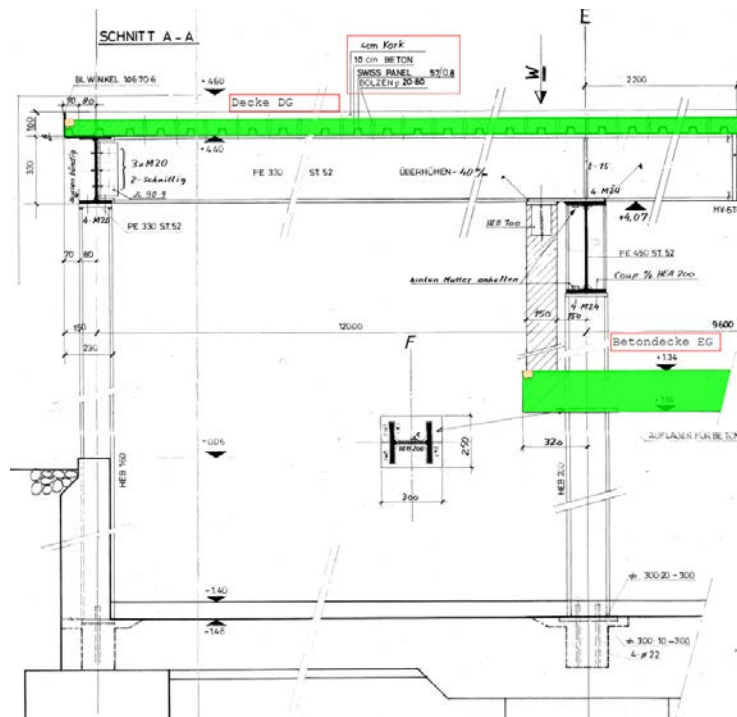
Schnitt und Detail Erd-Dachgeschossdecke
